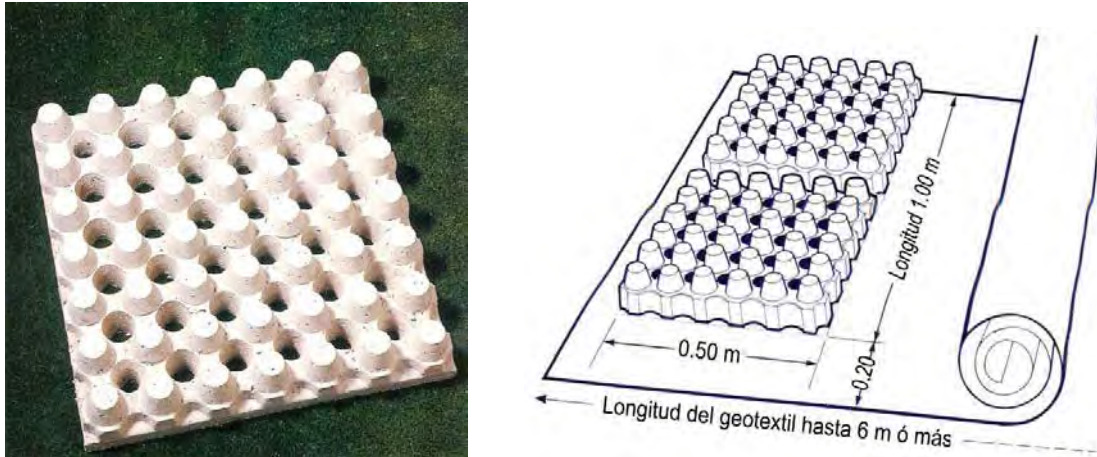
Detalle de pieza precolada de concreto colocada sobre geotextil
